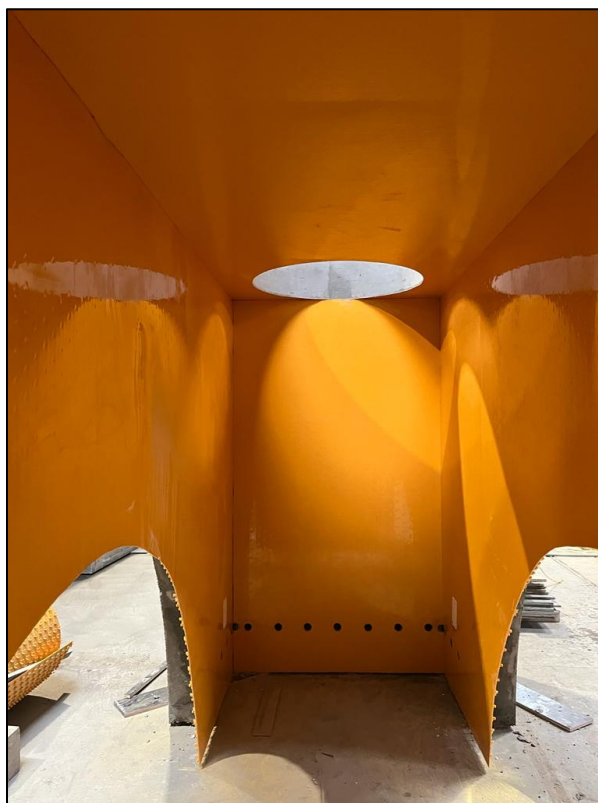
widok na element zbrojony z zamontowaną wykładziną, etap przed betonowaniem
